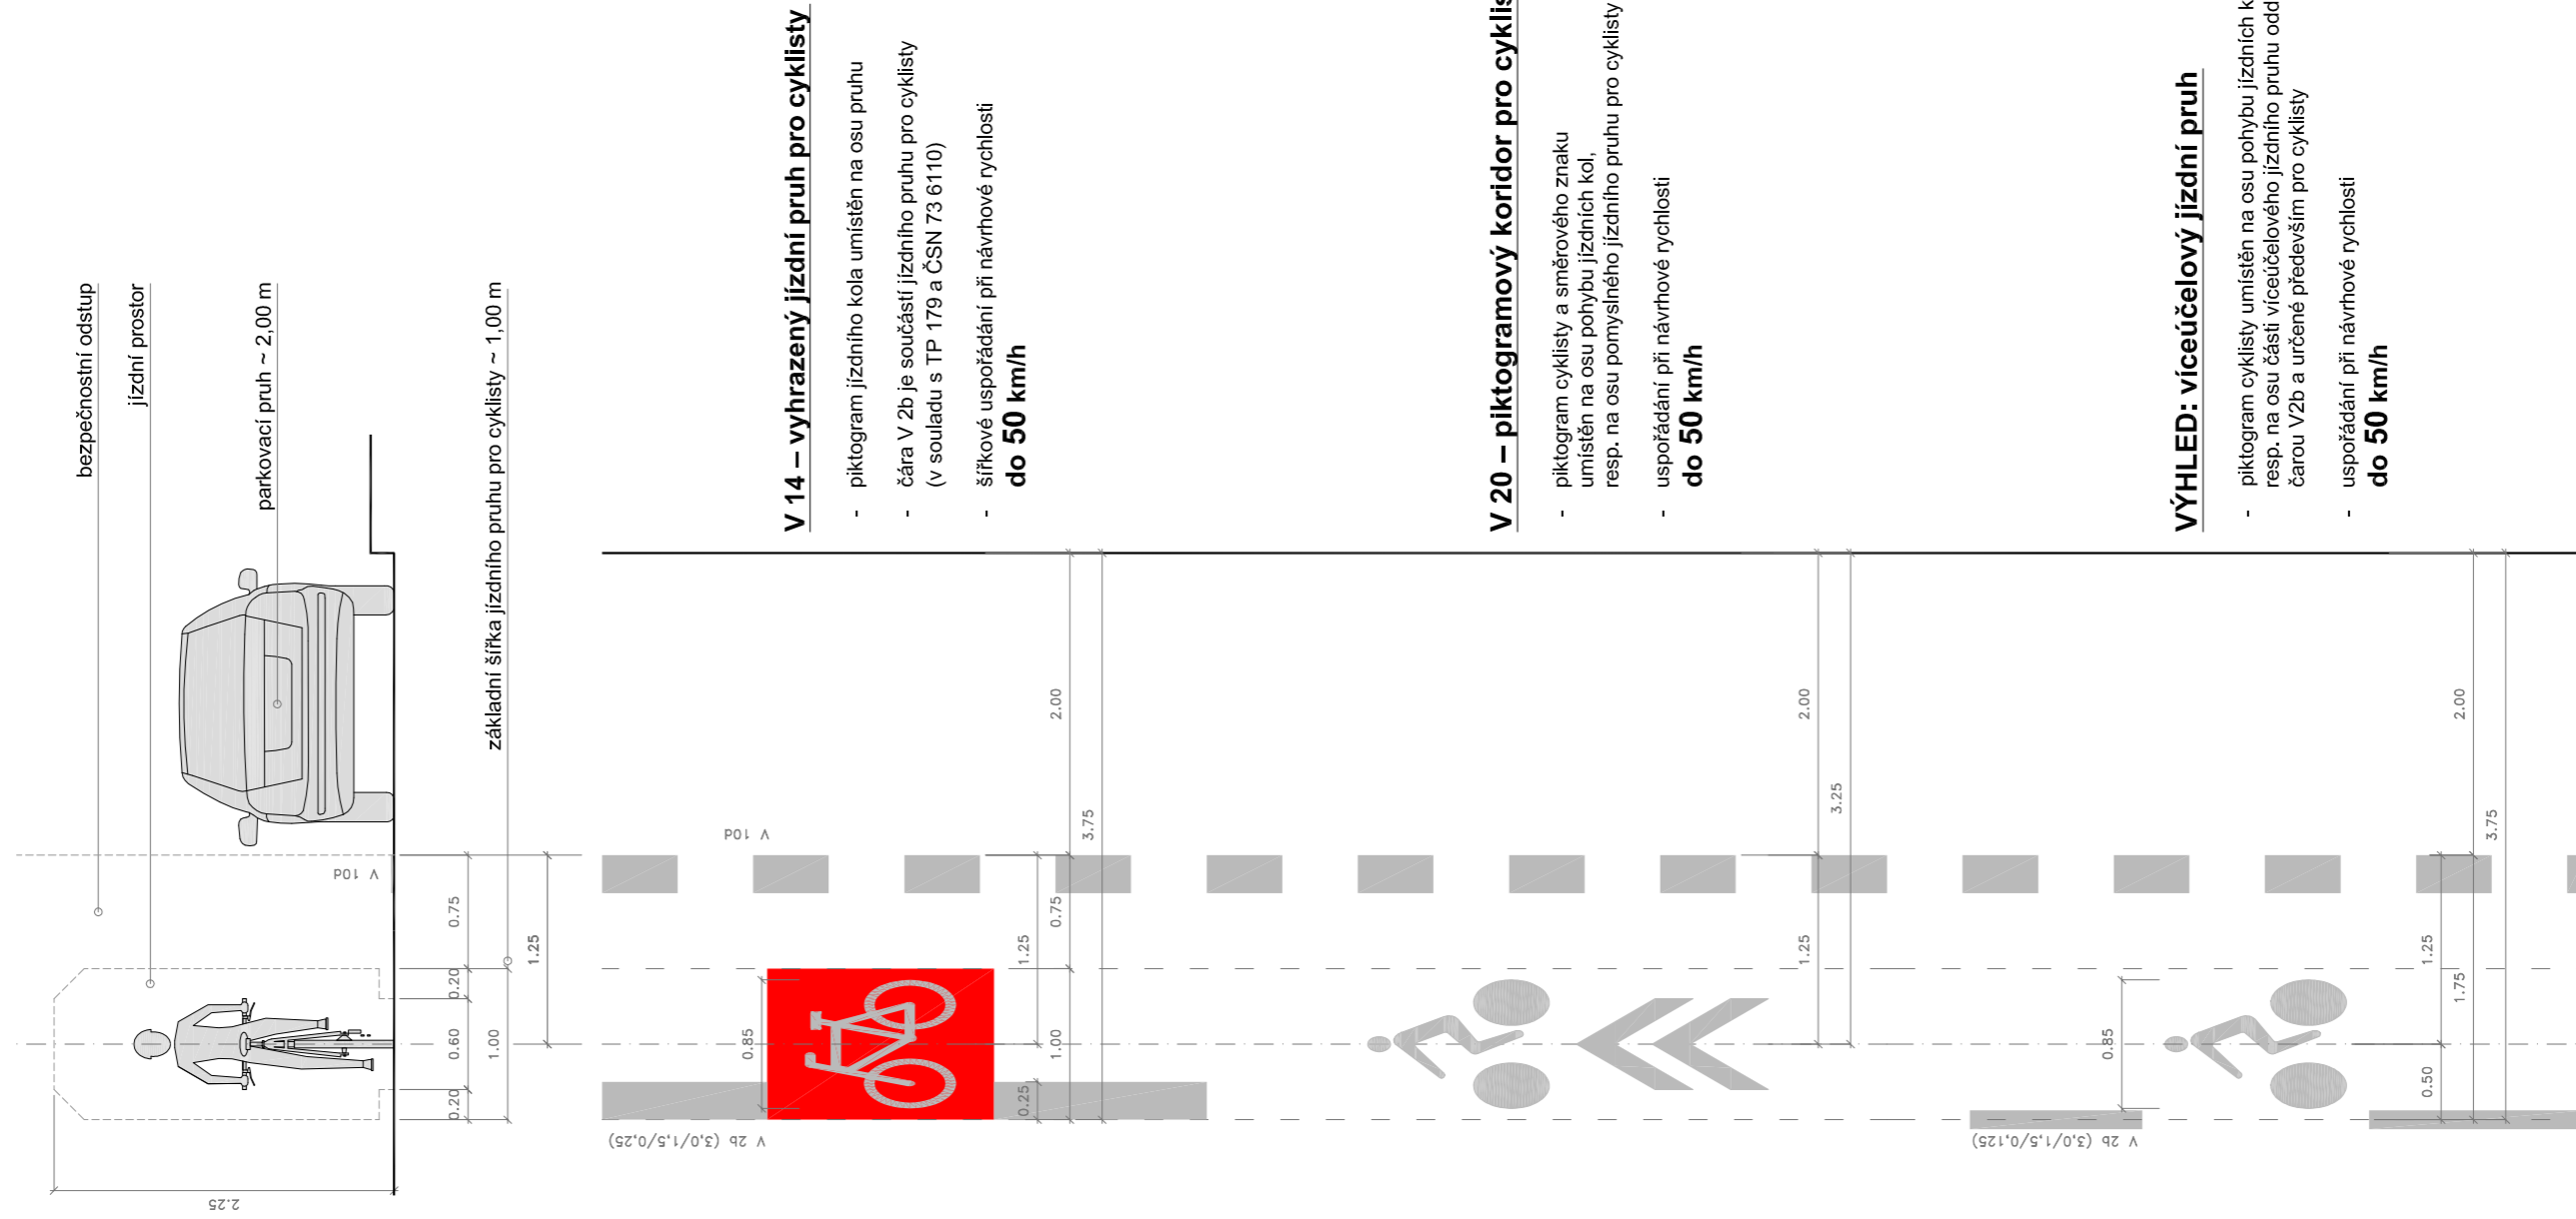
DETAILY ZÁKLADNÍCH ŠÍŘKOVÝCH USPOŘÁDÁNÍ U PODÉLNÉHO STÁNÍ
